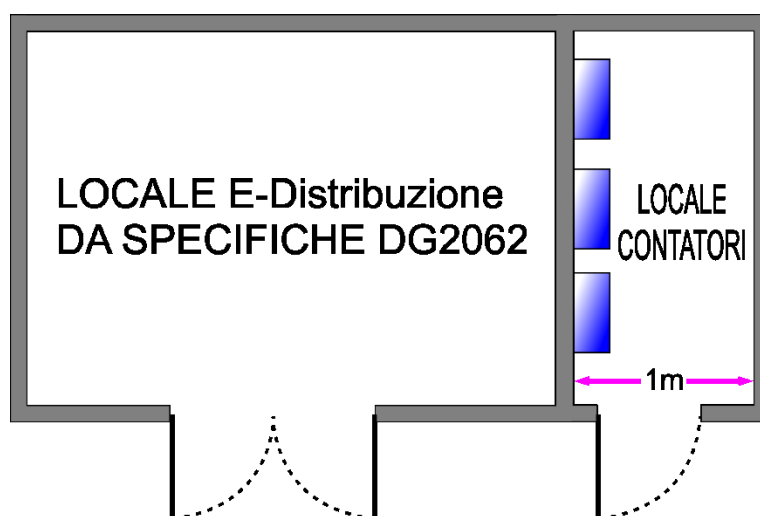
Layout indicativo cabina E-Distribuzione minibox con aggiunta locale a protezione contatori.
